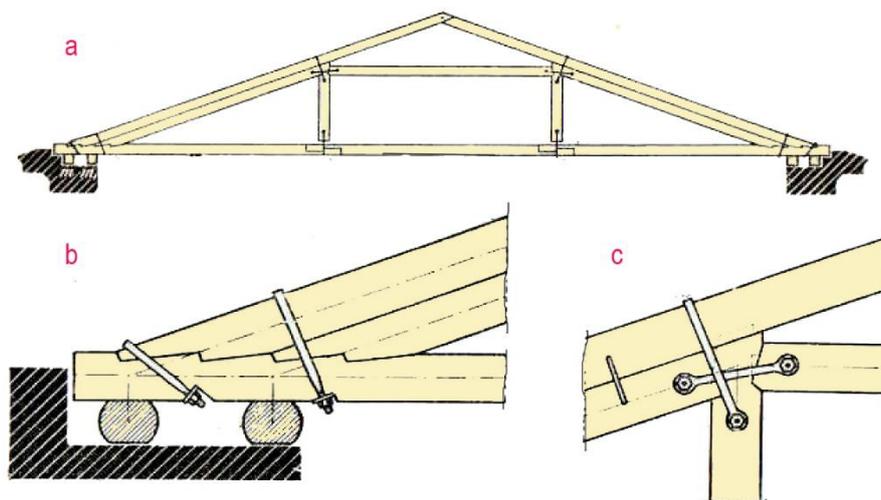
Висячие стропила двускатных крыш пролетом 13-18 м: а – общий вид стропильной фермы с двойной подвеской затяжки; б – сопряжение стропильной ноги, подмоги и затяжки с опиранием фермы на двойной мауэрлат; с – сопряжение стропильной ноги, подмоги, ригеля и бабки [33]
